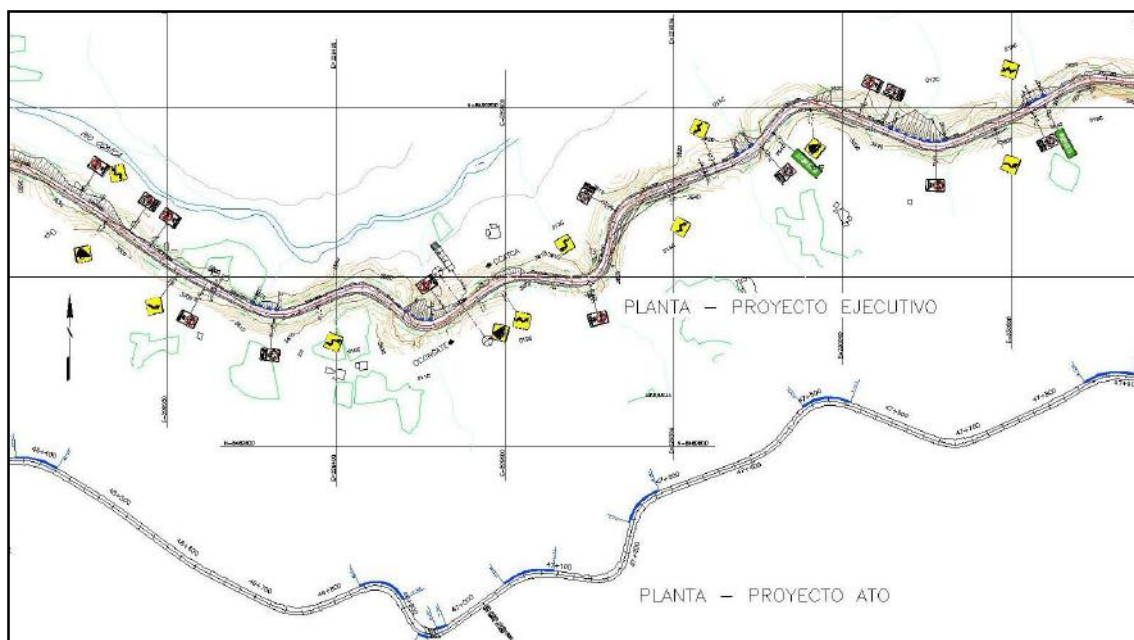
Sinalização - Planta do km 46+400 ao km 47+900 do Projeto Executivo e Projeto ATO.
